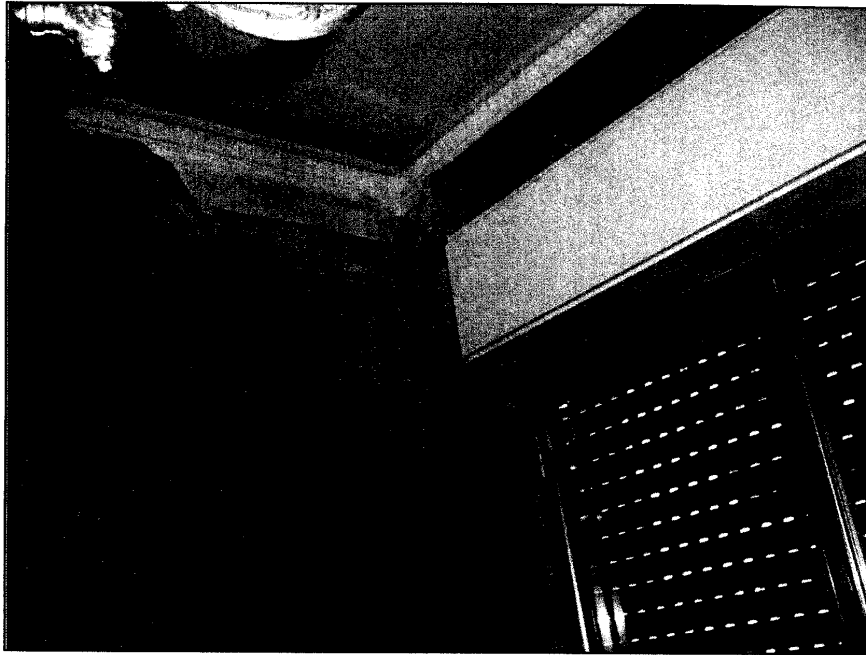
tracce di umidità sul soffitto della camera da letto dovuta ad un deperimento dell'isolamento del piano terrazza
